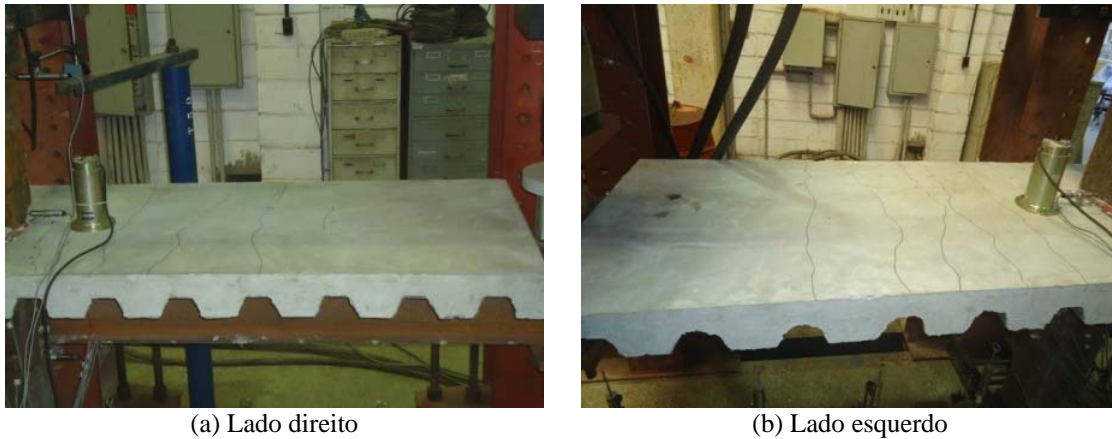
Fissuração na laje do Modelo 2.
